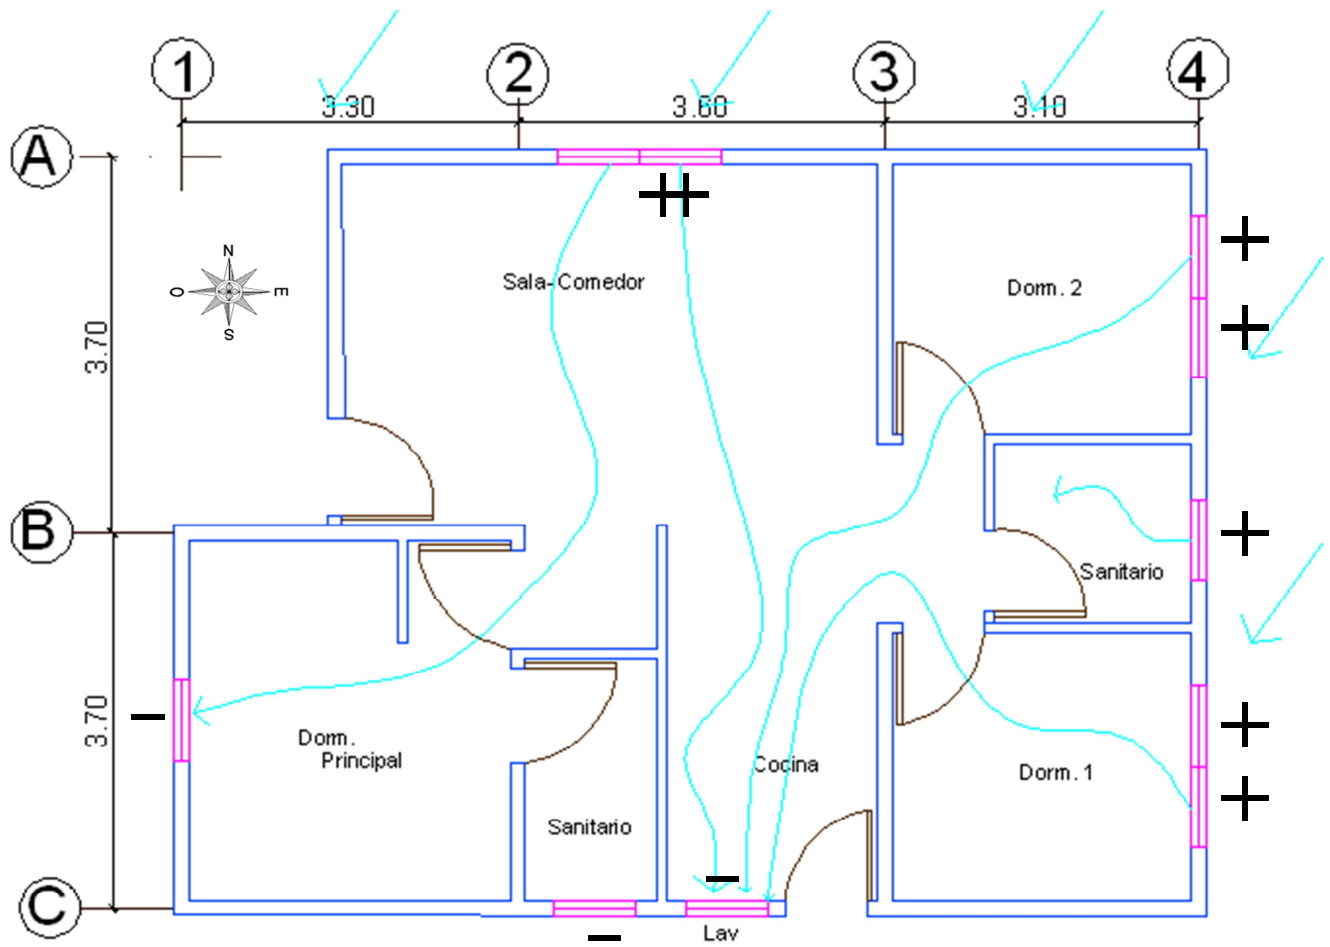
Ventilación cruzada en planta modelo 3. Petrocasa
